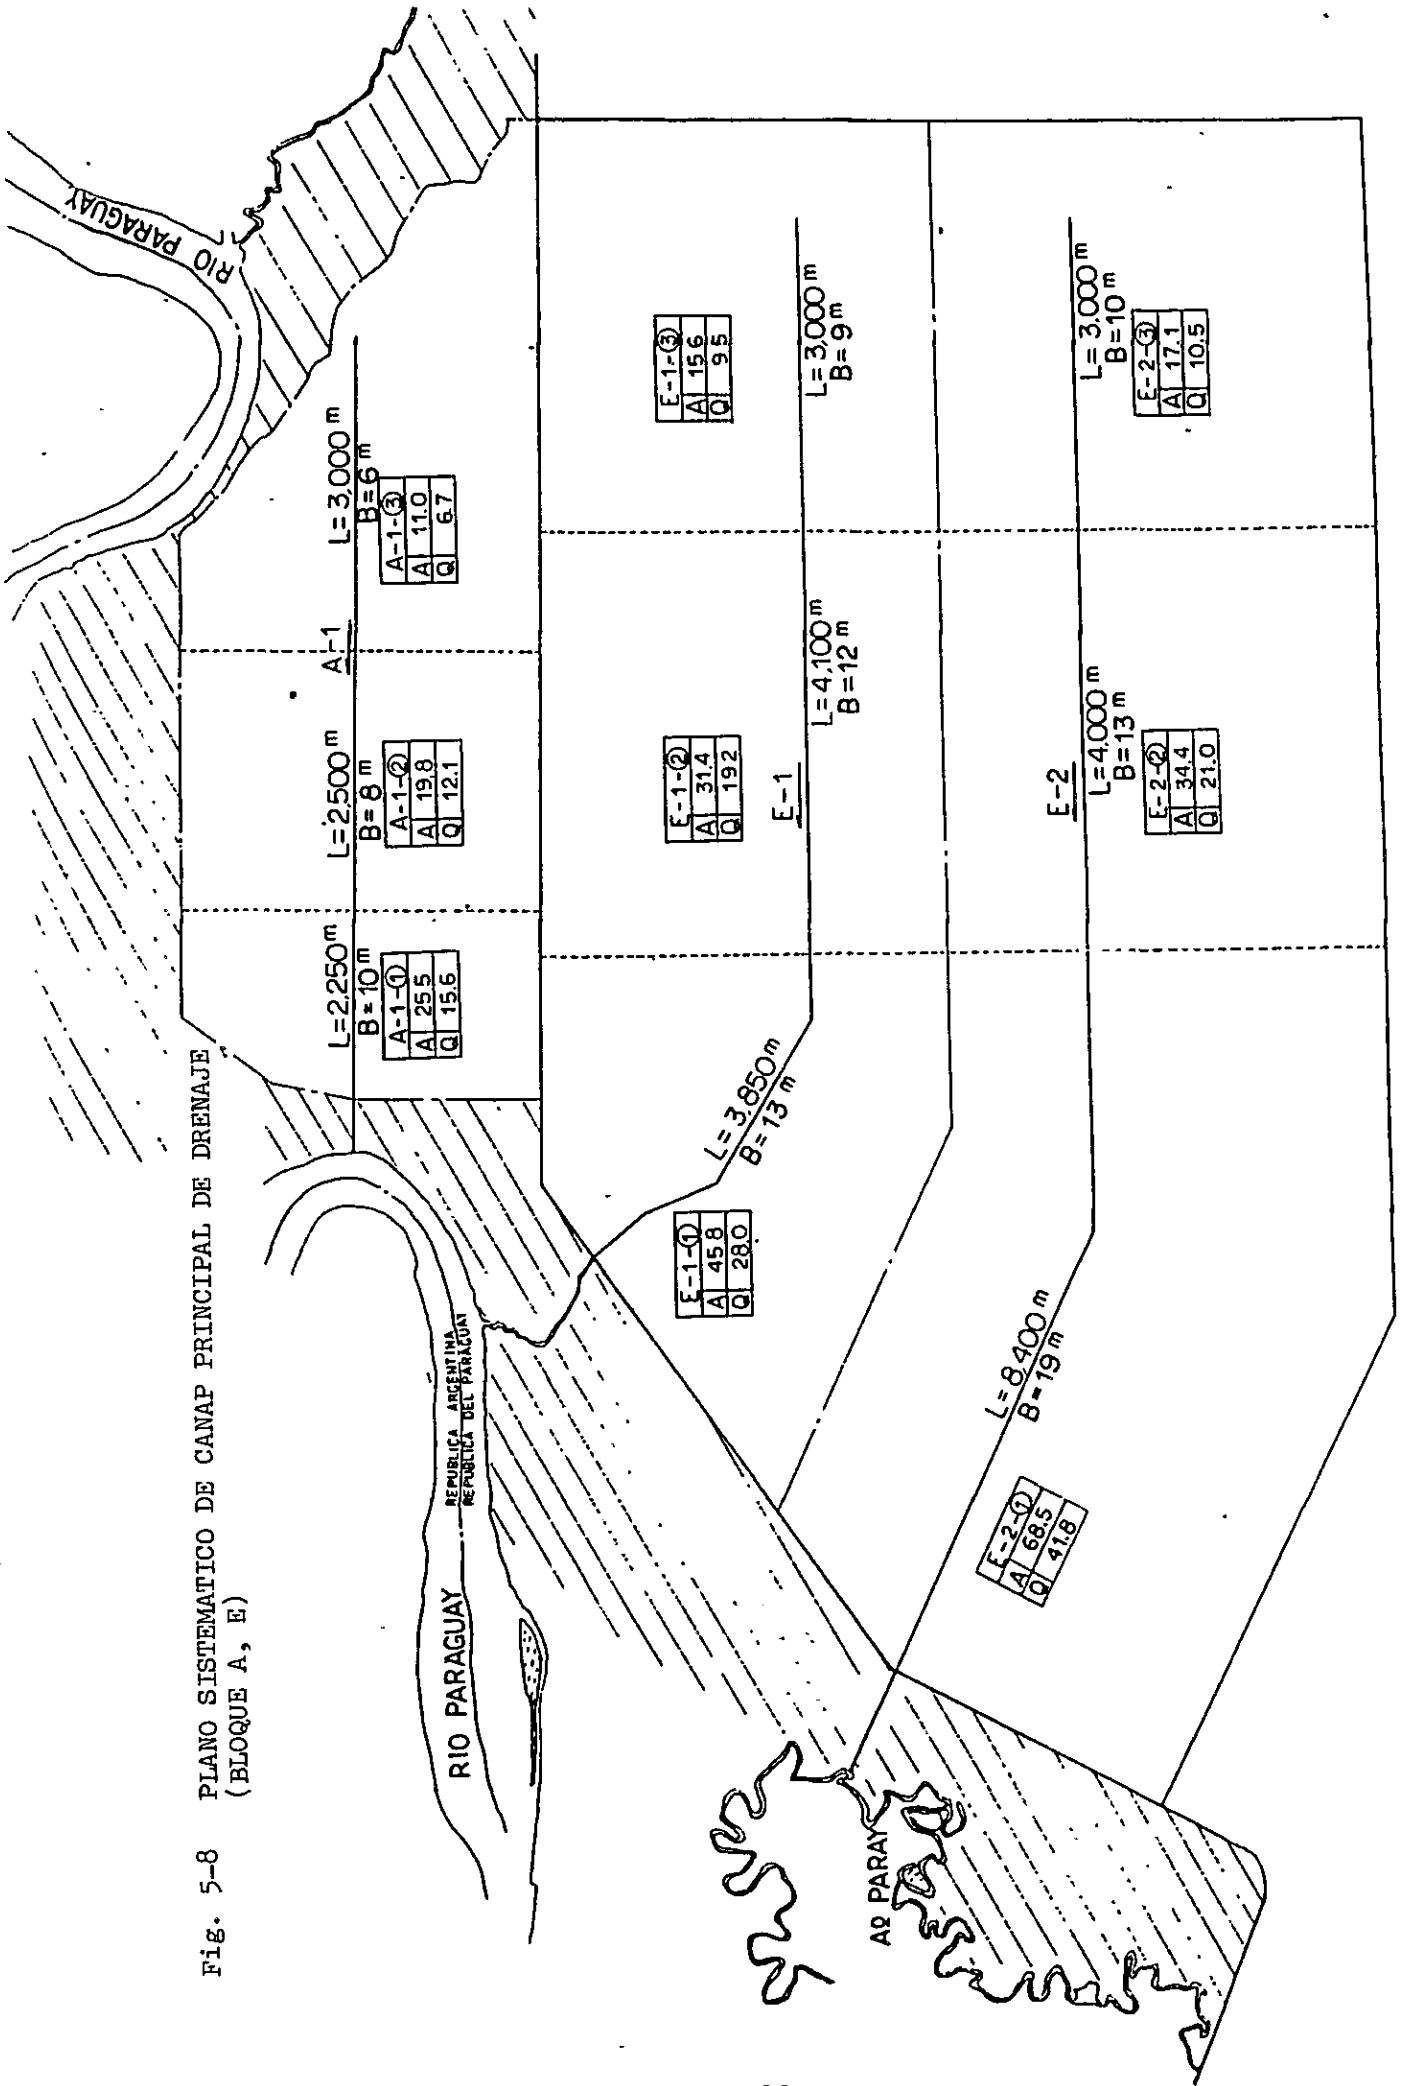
PLANO SISTEMATICO DE CANAP PRINCIPAL DE DRENAJE (BLOQUE A, E)
